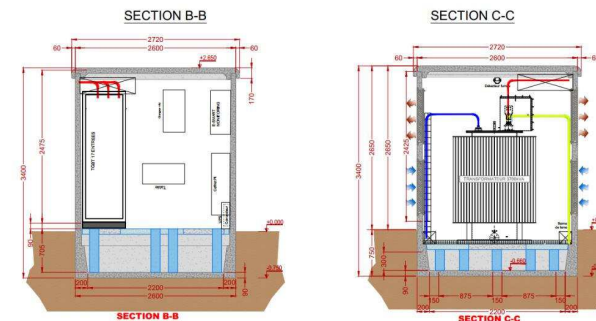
Exemple de plan de coupe de côté d'un PTR (Source : SOLARVIA)
